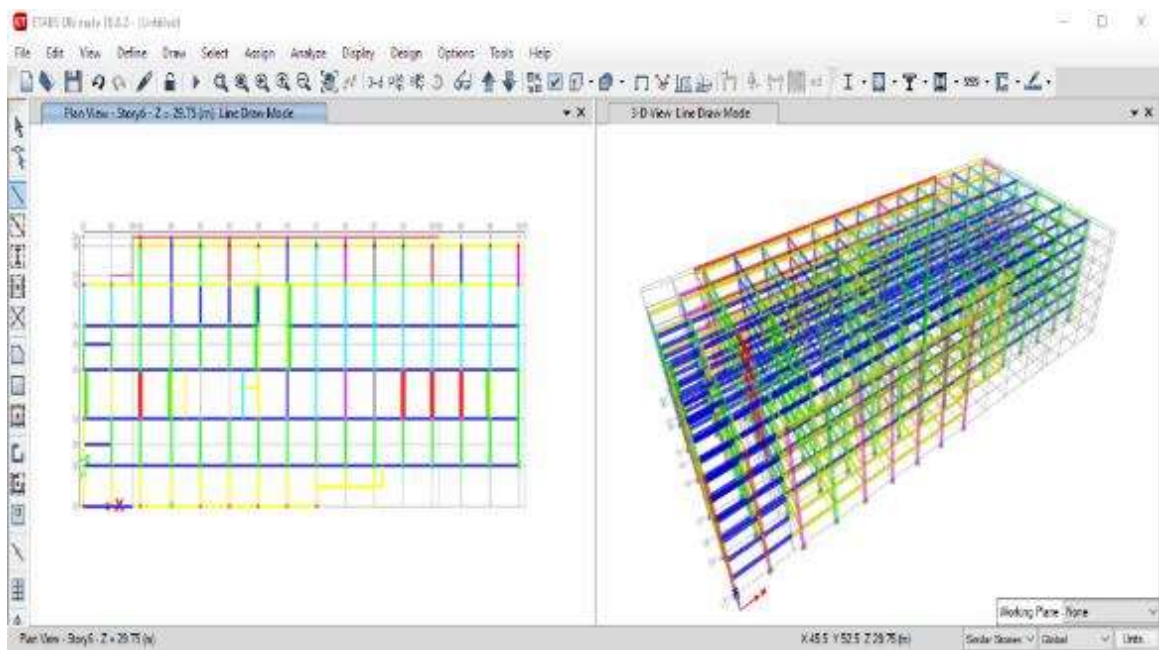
Colocación de vigas y columnas en la cuadrícula.
